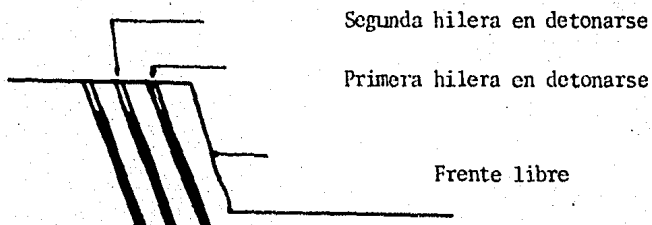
Desmoronamiento por la detonación de un barreno.
